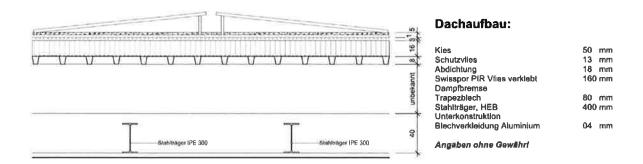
, Detailschnitt mit Dachaufbau und PV-Anlage
